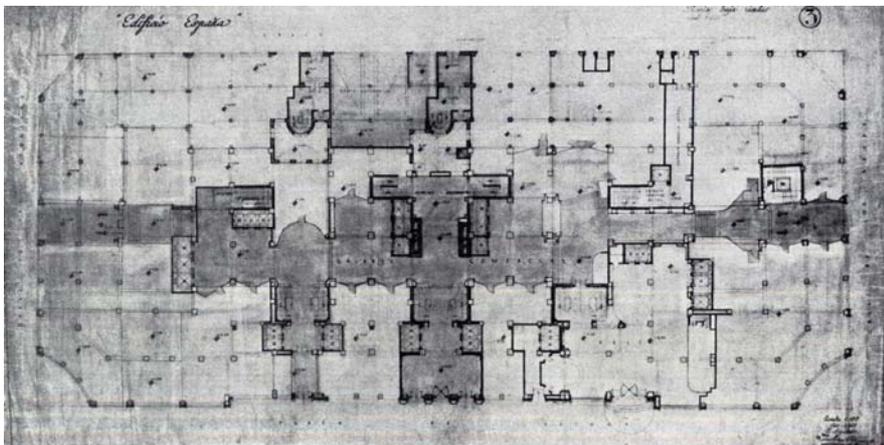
Planta baja con la galería comercial resaltada, publicada en *Cortijos y Rascacielos*, nº 75-76, 1953; pág. 50.
